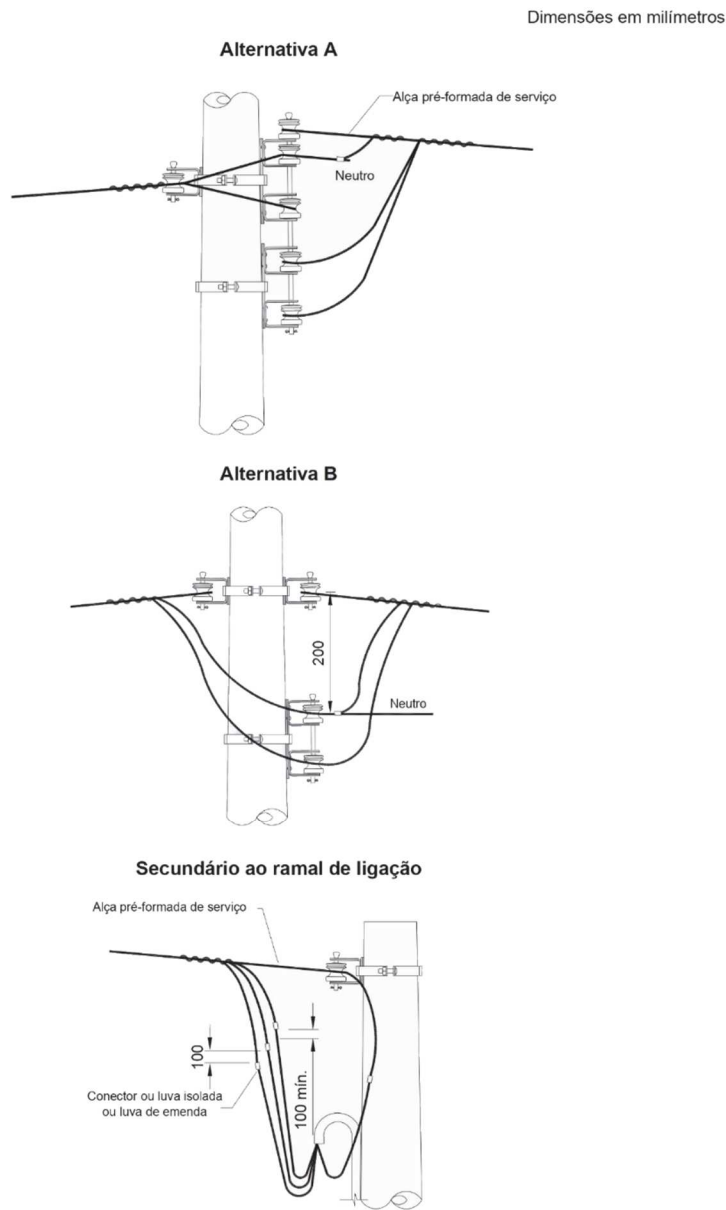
Amarrações e ligações – Secundário - Ligações de consumidores- Poste de concreto e seção circular
